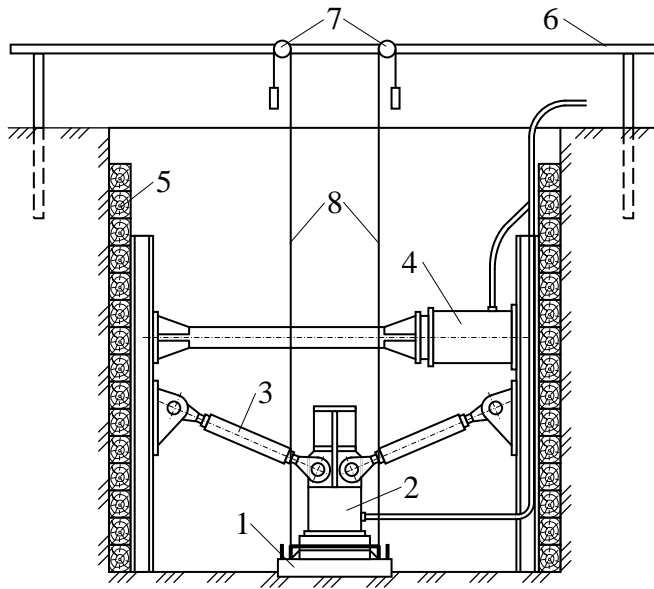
Схема установки для випробування ґрунту штампом розпірної конструкції у шурфі: 1 – штамп; 2 – домкрат для навантаження штампa; 3 – гвинтові упори; 4 – домкрат для горизонтального розпору; 5 – вінцеве кріплення; 6 – реперна система; 7 – прогиномір; 8 – дріт
